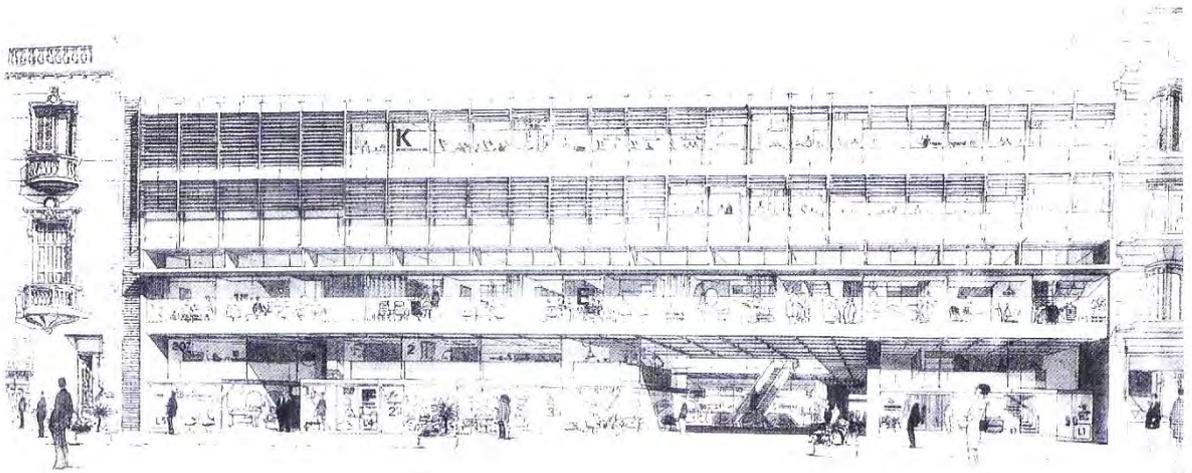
Croqui da Fachada do Centro Comercial junto a Rua Florida.
